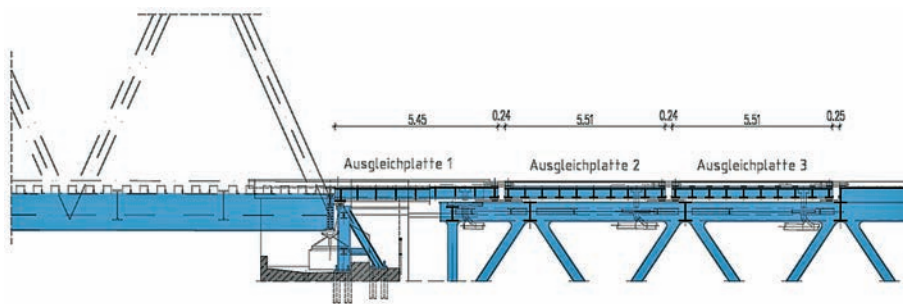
Detaillängsschnitt Übergang Rheinvorlandbrücke/Rheinbrücke mit drei Ausgleichsplatten
